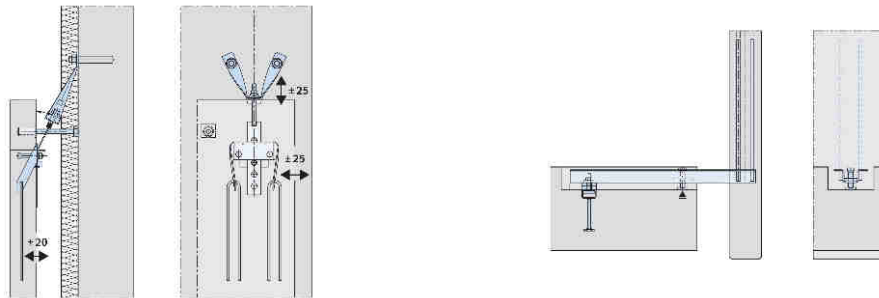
Halben Anker für großformatige Fassadenplatten: links Fassadenplattenanker, rechts Brüstungsanker
